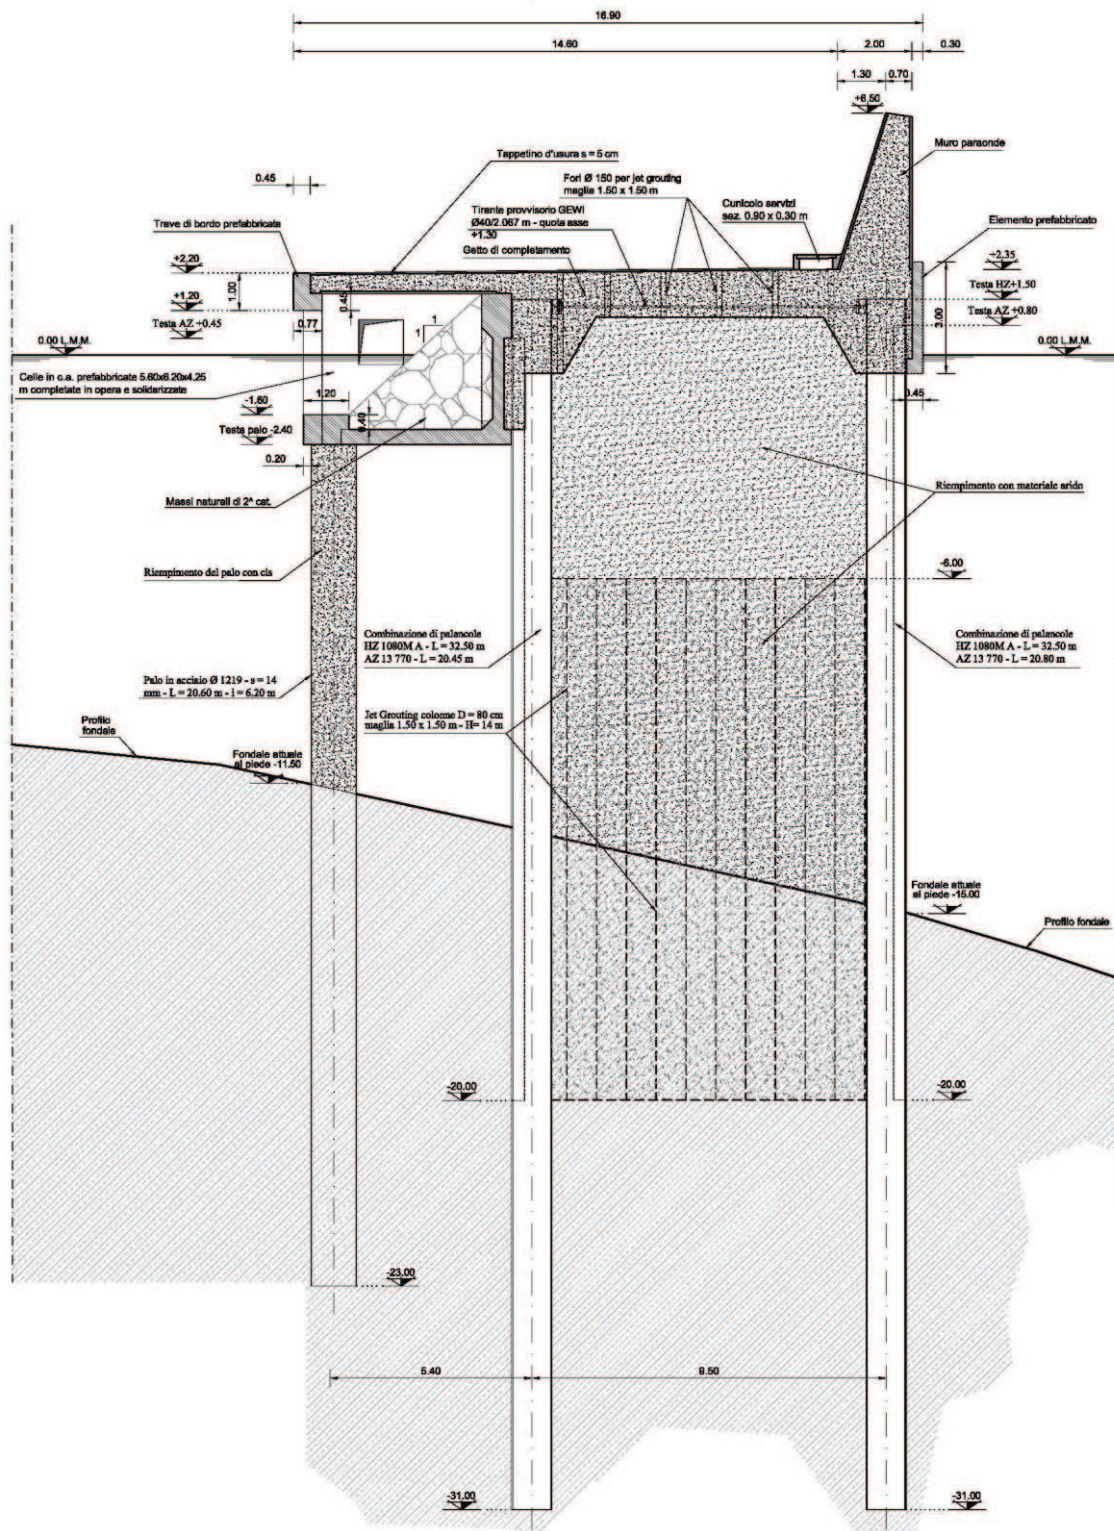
Sezione tipologia molo sopraflutto (PROGETTO SIGENCO).
